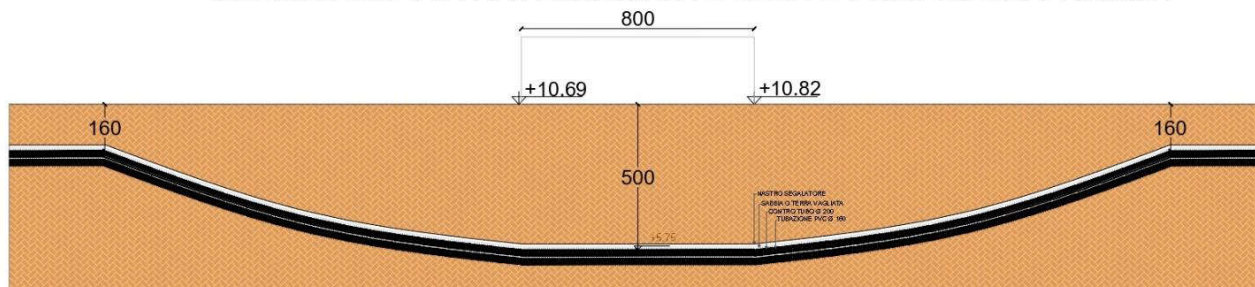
Tratto D-D' - Sezione attraversamento proprietà privata
